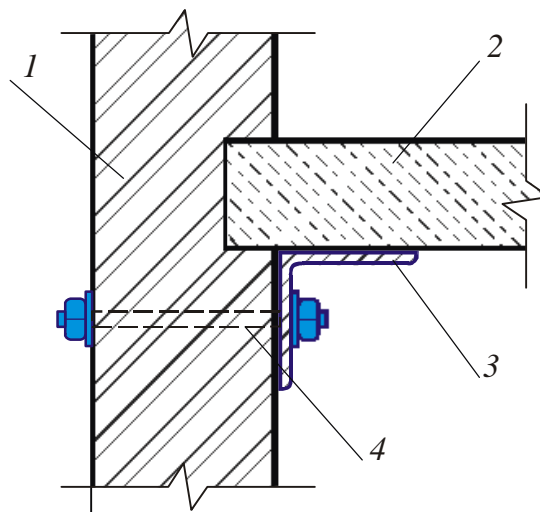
Усиление опорной площадки плиты перекрытия:
